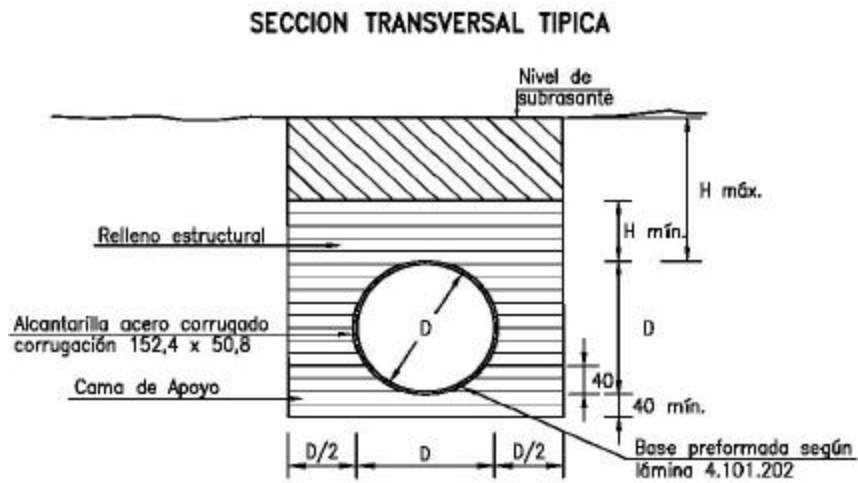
Sección típica, tubo acero corrugado 152,4 x 50,8.
